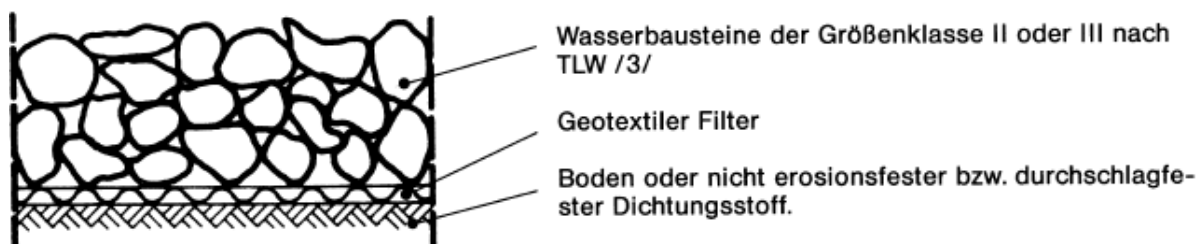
Schematische Darstellung einer durchlässigen Deckschicht aus losen Wasserbausteinen im Querschnitt [48];[73]
